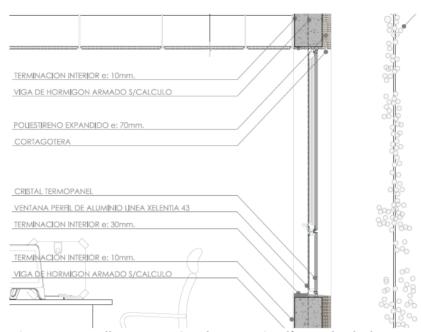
Detalle constructivo de muro Fiscalía Local Talcahuano
